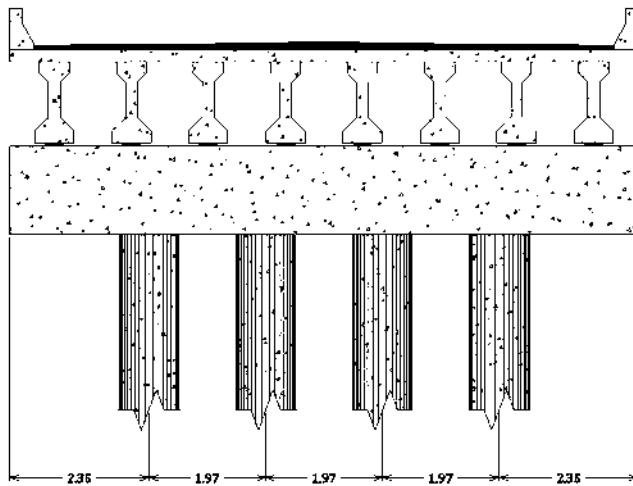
Espaciamiento entre columnas en pilas con altura $5 \leq h \leq 15$ (m) (acotación en metros)
